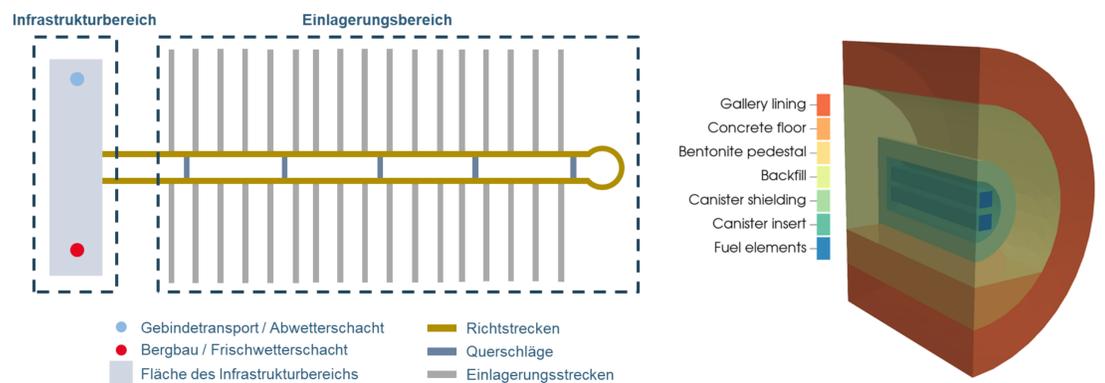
Schematische Darstellung des Layouts eines Endlagerbergwerks (links) und einer Einlagerungsstrecke (rechts) im Tongestein für die Streckenlagerung. Quelle: BGE
